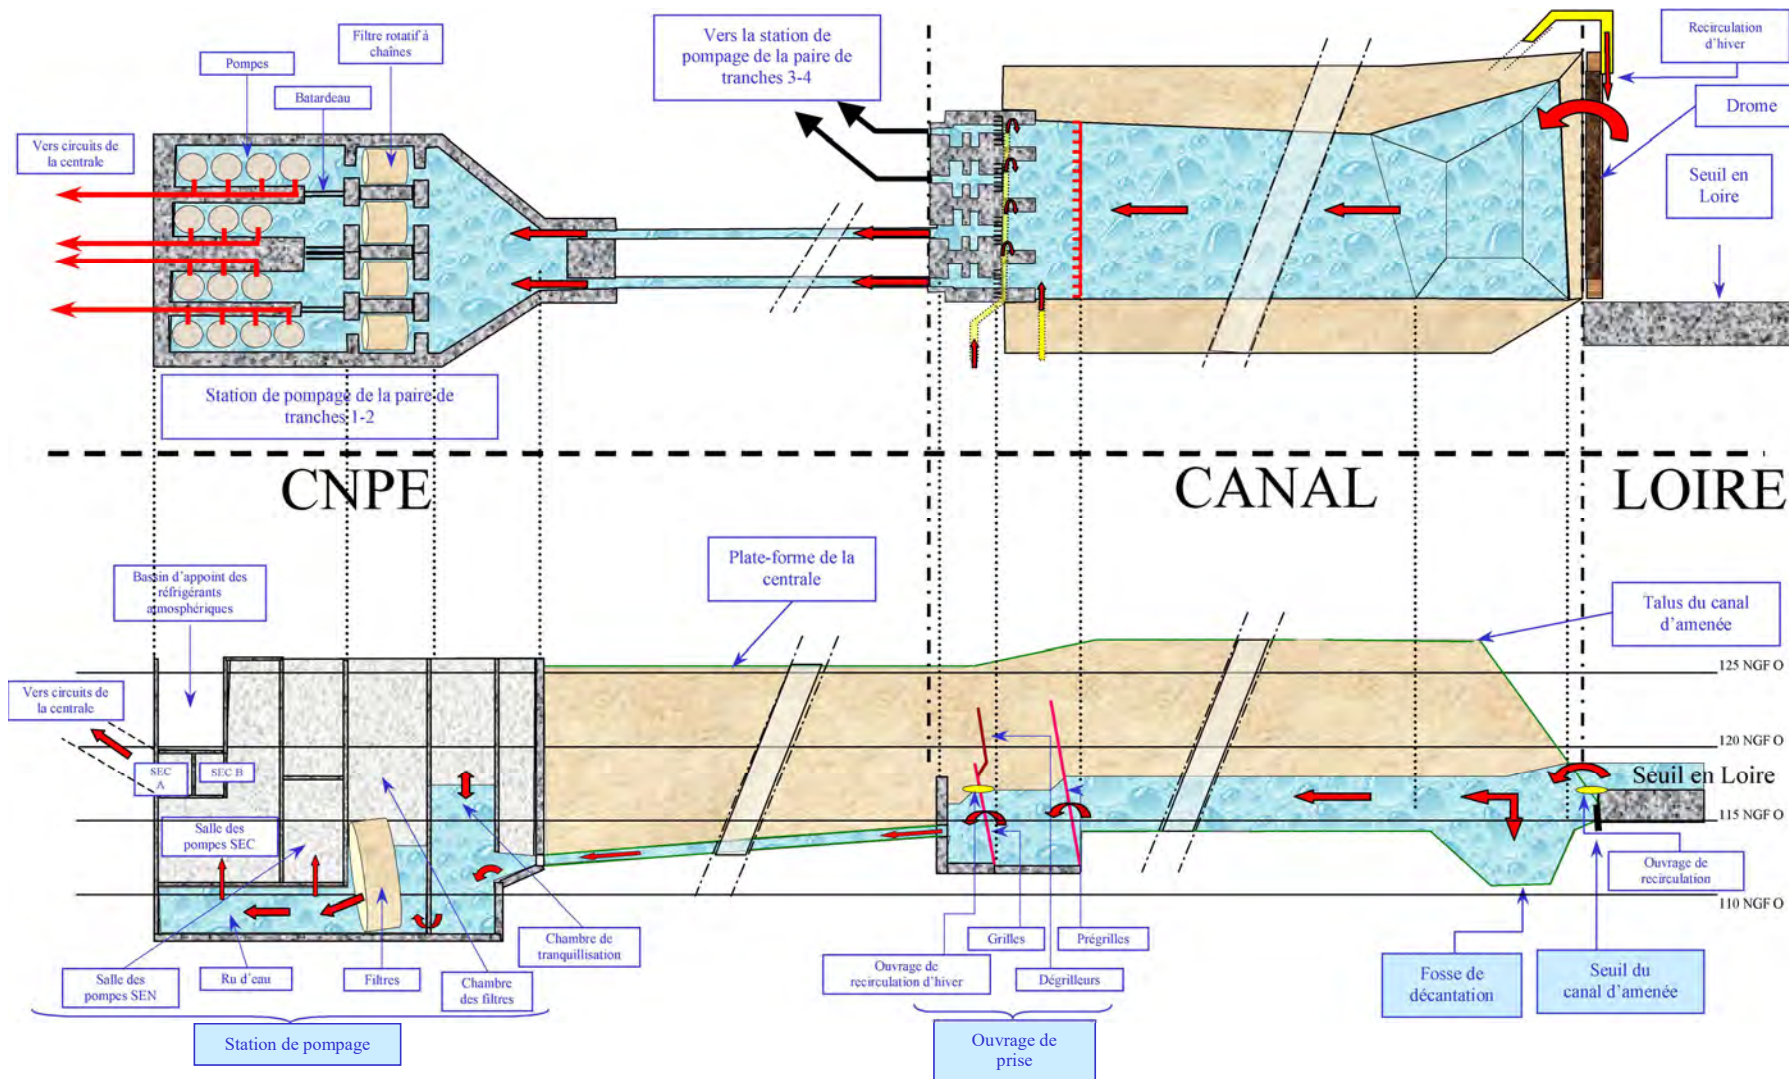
Vue en coupe et en plan des ouvrages de prise d'eau
